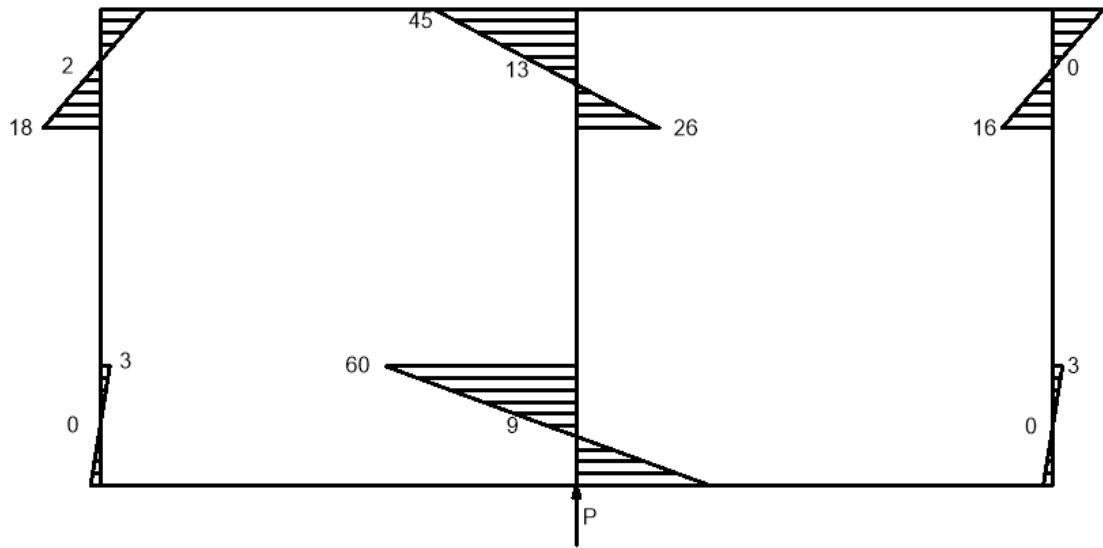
Схема испытания двух пролетного фрагмента перекрытия из многопустотных плит на горизонтальную нагрузку [90].
